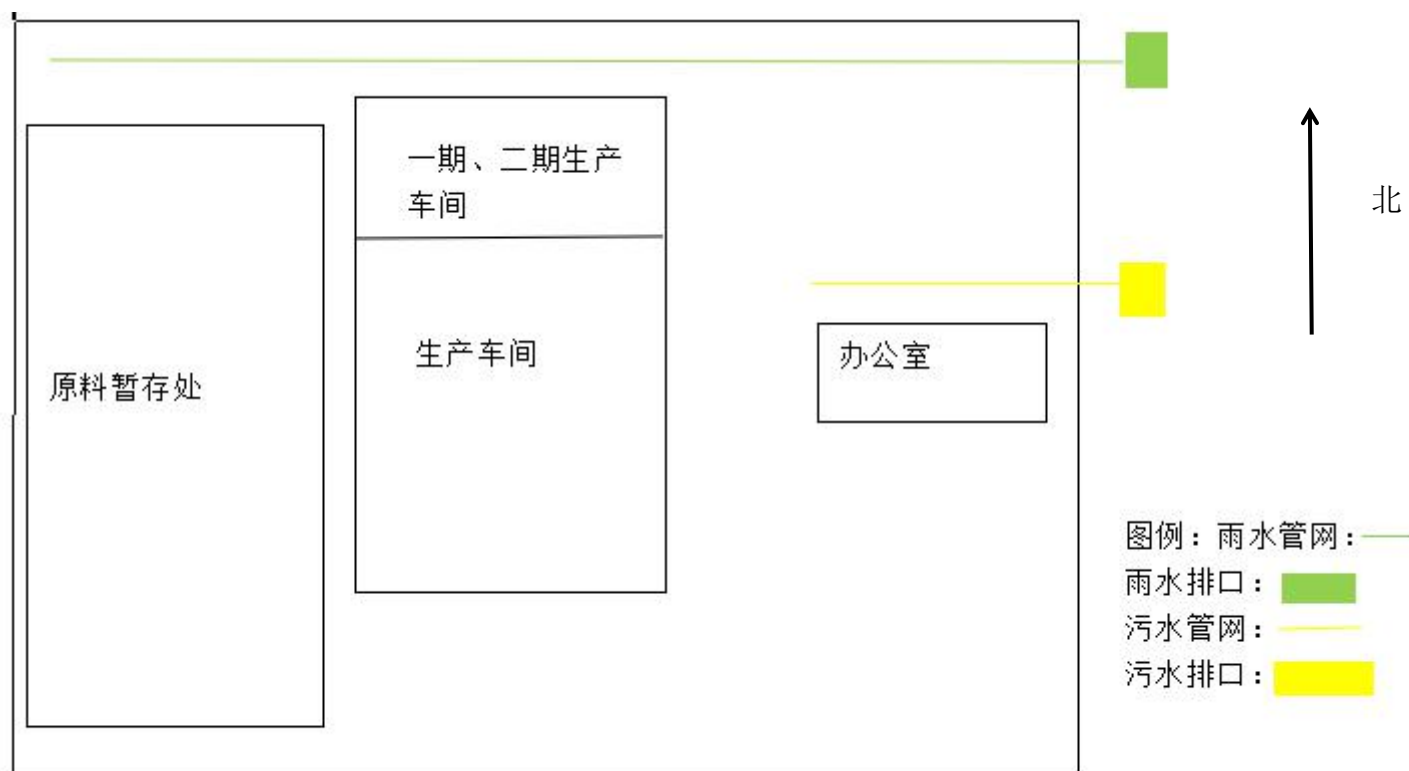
建设项目总平面布置图 比例尺：1：5000
